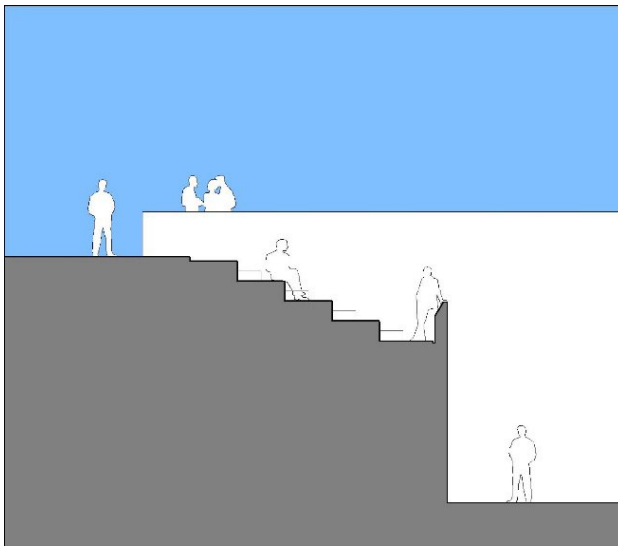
Sección del Puerto Mirador. Fuente: elaboración propia.
